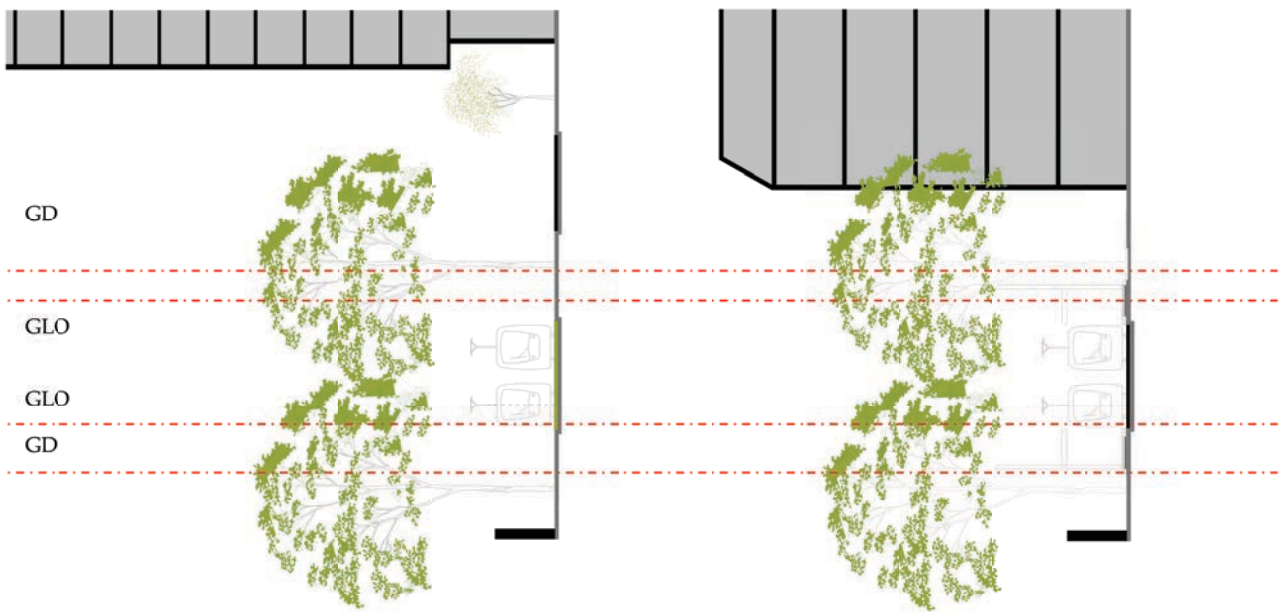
Sección transversal A-A, calle Wellington. Fuente: elaboración propia.
